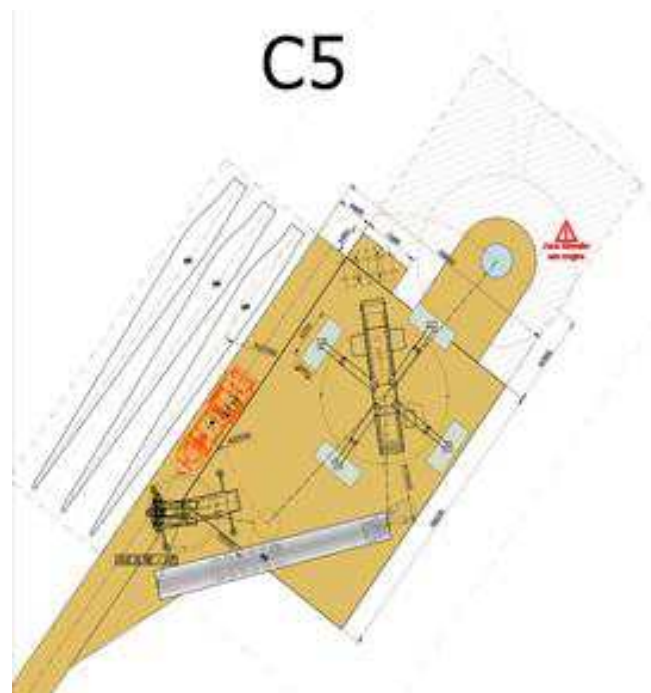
Plan de construction de l'éolienne C05 à Caix (par existant)
